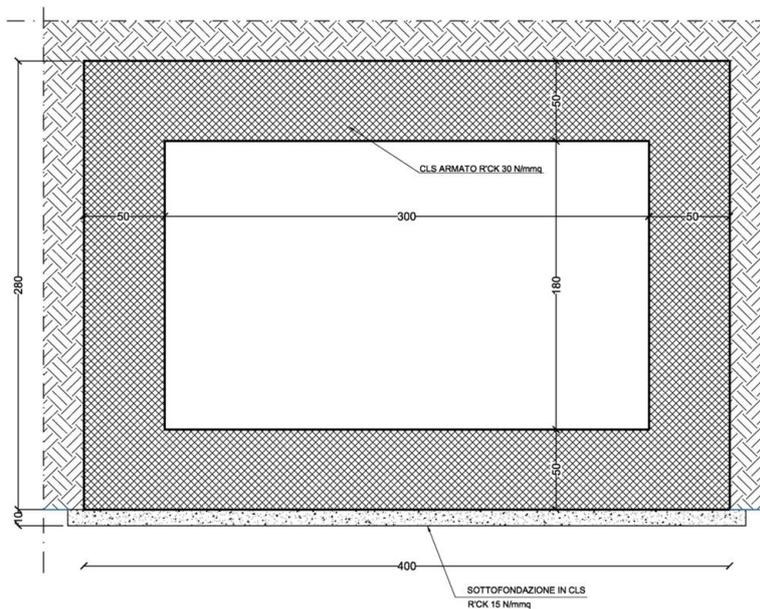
Compluvio nord – Canale in c.a. gettato in opera
